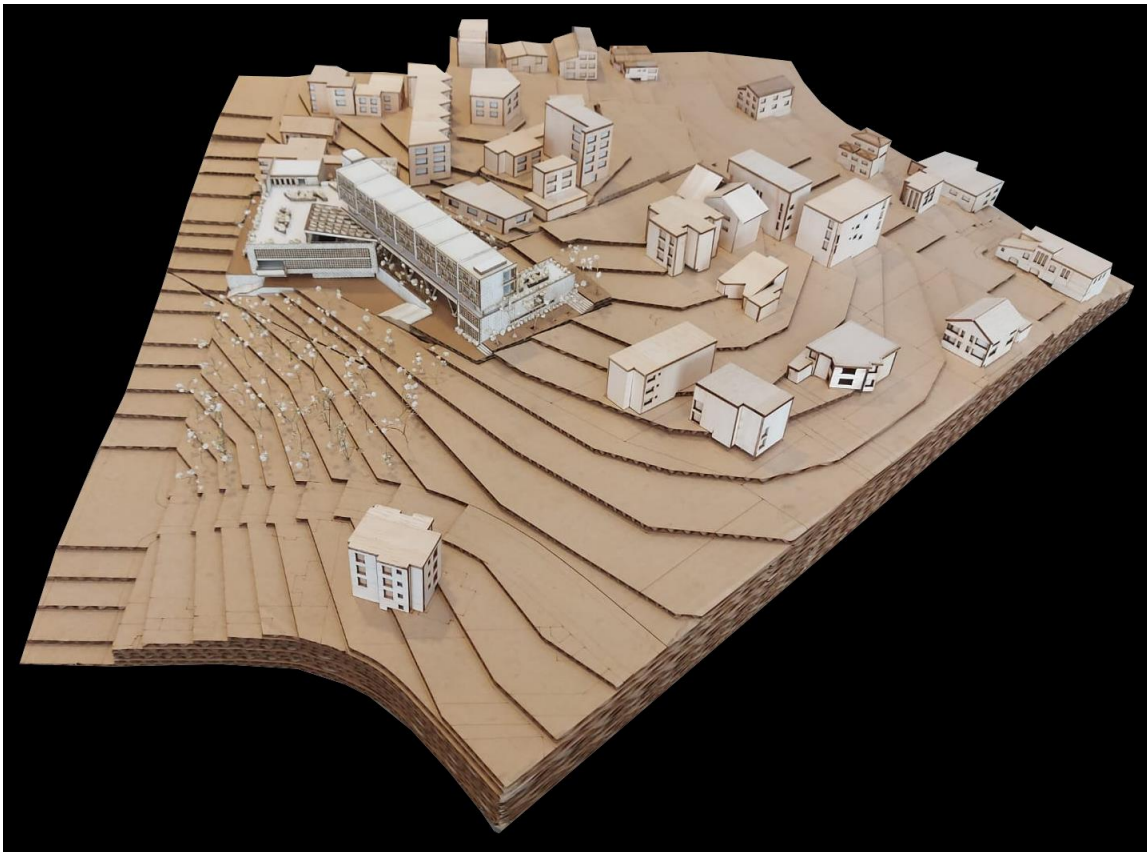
Maqueta escala 1:250 - vista 2. Por: Elaboración propia.
